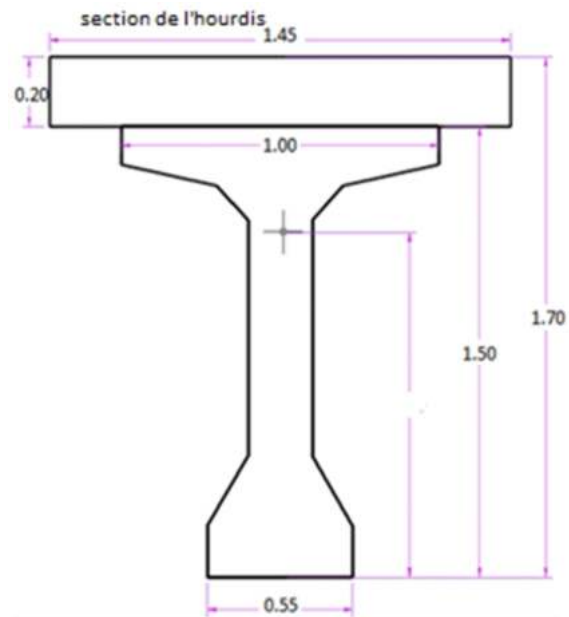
les dimensions de la section de la poutre+l'hourdis à mi-travée
